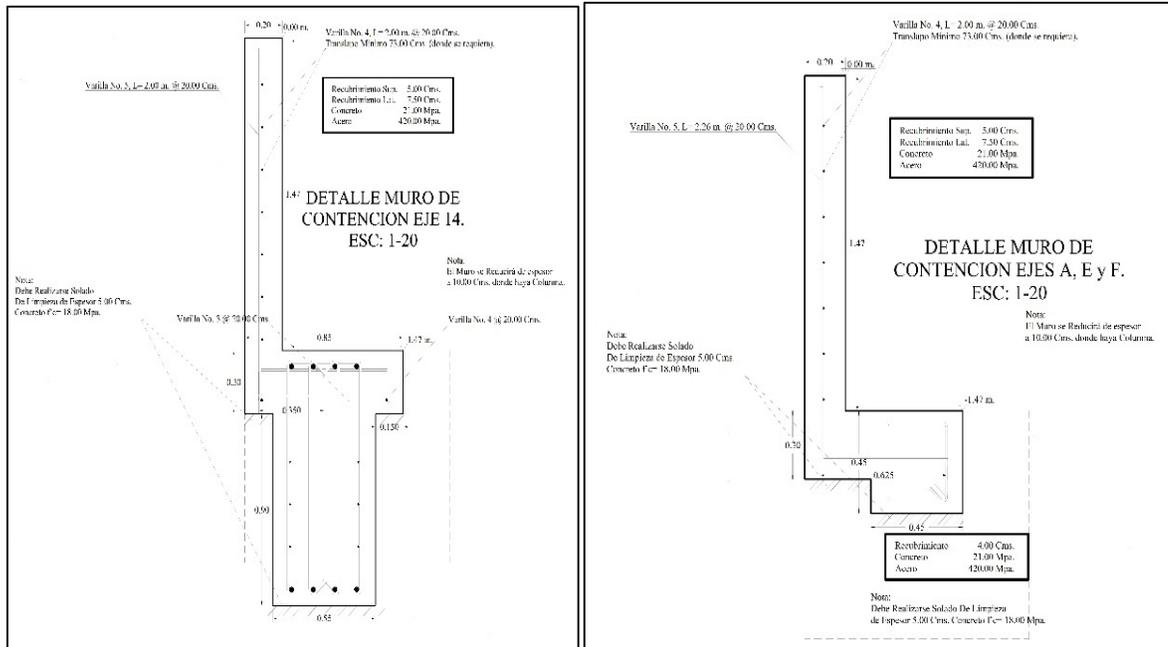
, Detalle Muros de contención eje 14, y ejes A, E-F Fuente: Constructora Open House
